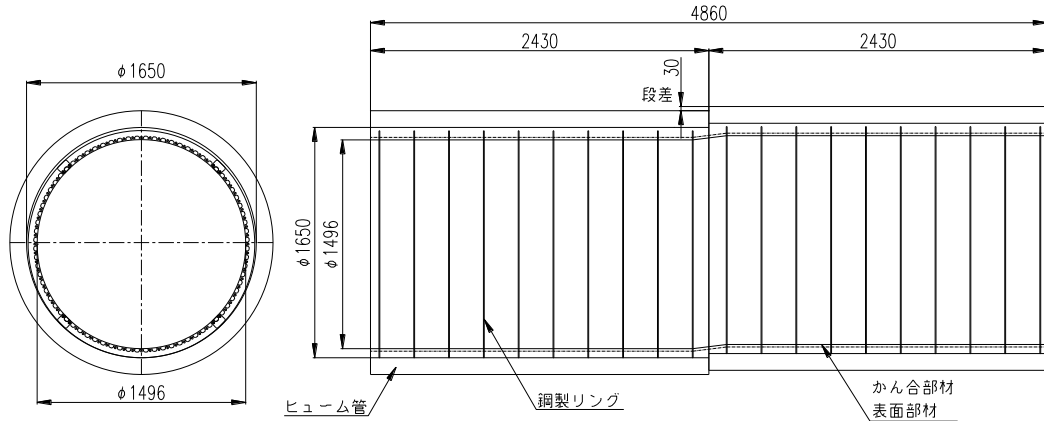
円形管段差部の施工性試験の配管図 (単位 mm)
